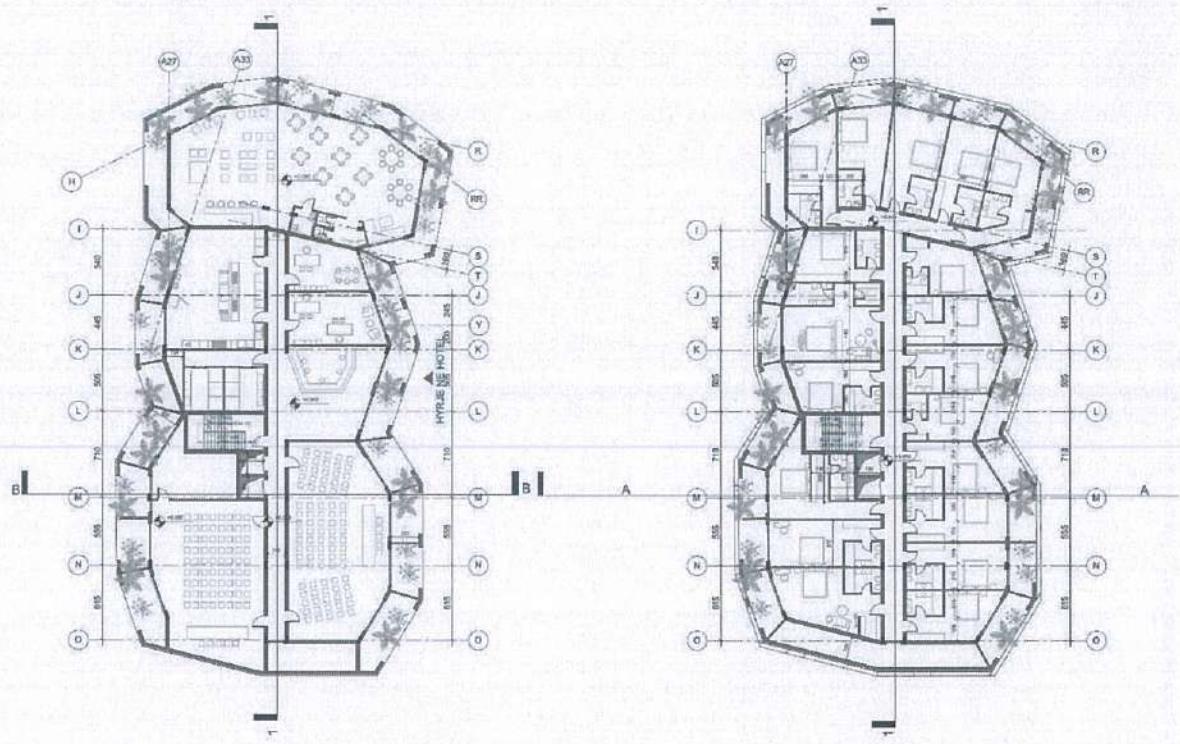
Plani i katit Odhe +1\_Hoteli 2
